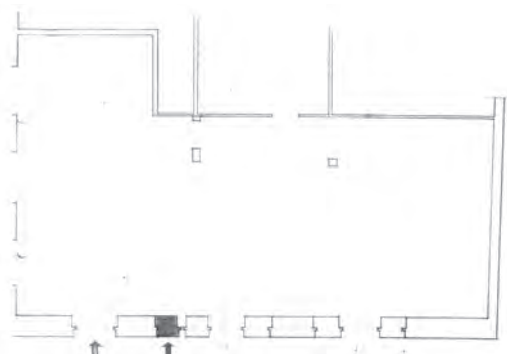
24. 1955. PLANTA BAJA CON UBICACIÓN DE HUECOS A MODIFICAR
